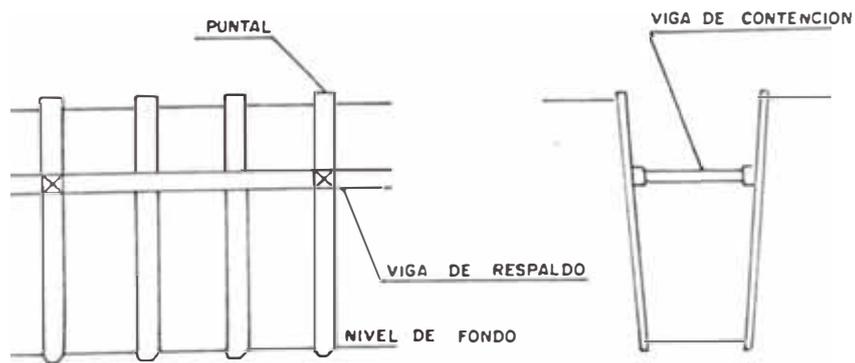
Apuntalamiento de zanjas y cámaras
